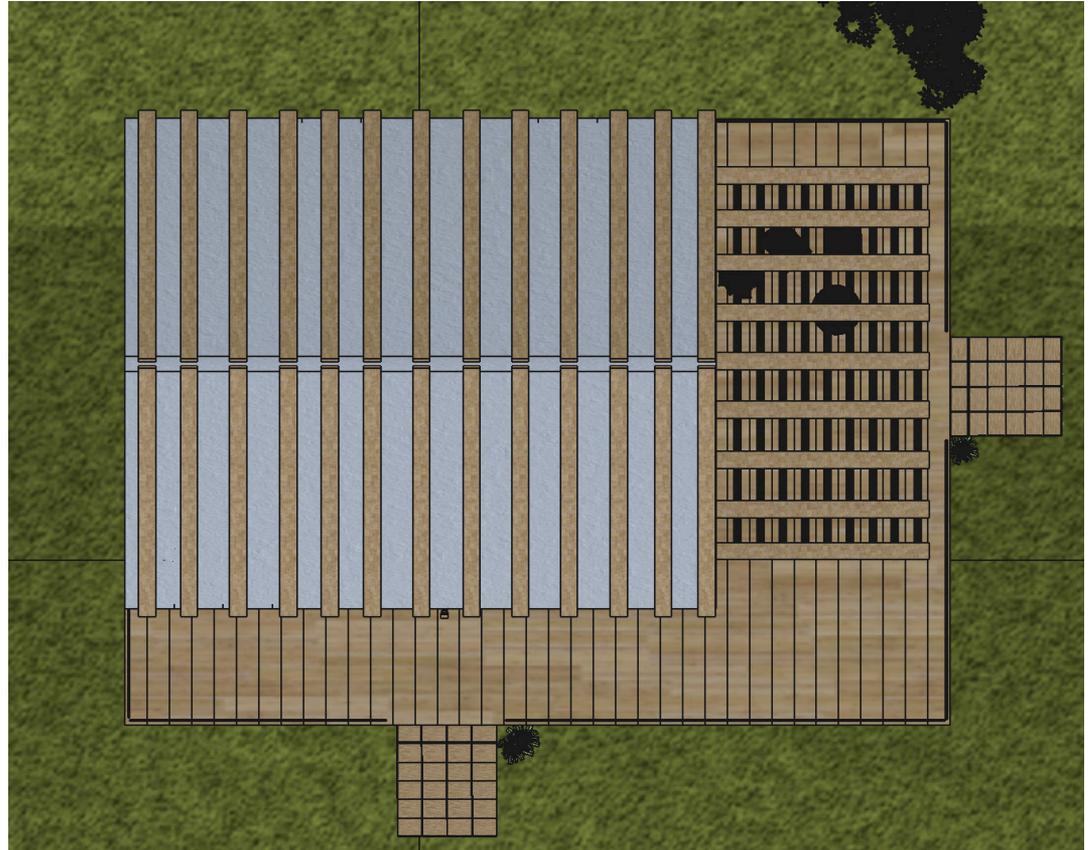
Vista alzada del modelado 3D de la vivienda. Fuente: autoría propia.
